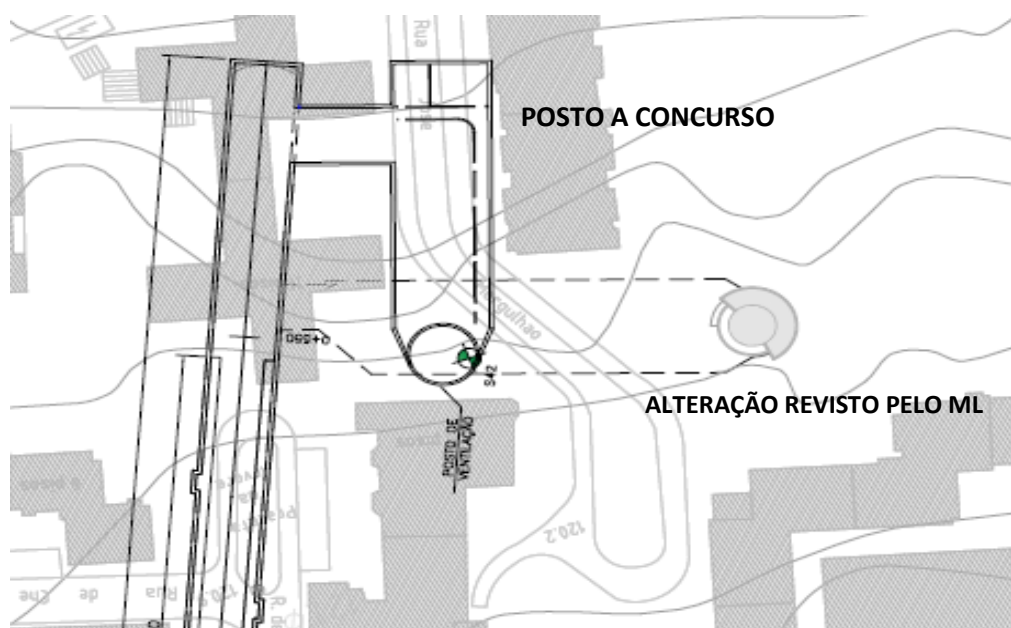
Projeto inicial da localização do poço de ventilação (Adaptado ML, 2008).
